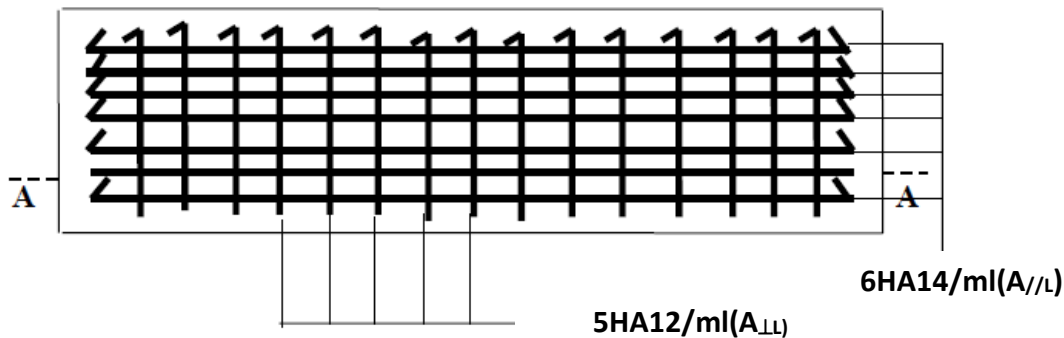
Schéma de ferrailage de la semelle filante sous poteaux.
